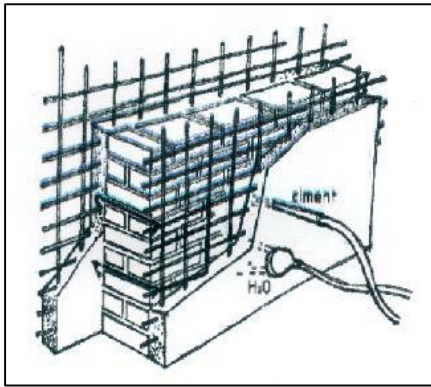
Consolidation d'un mur en pierre par parois armées.
